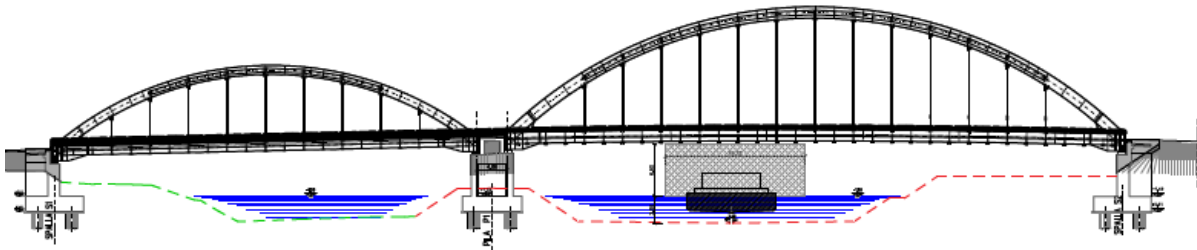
Prospetto del nuovo Ponte di Final di Rero
